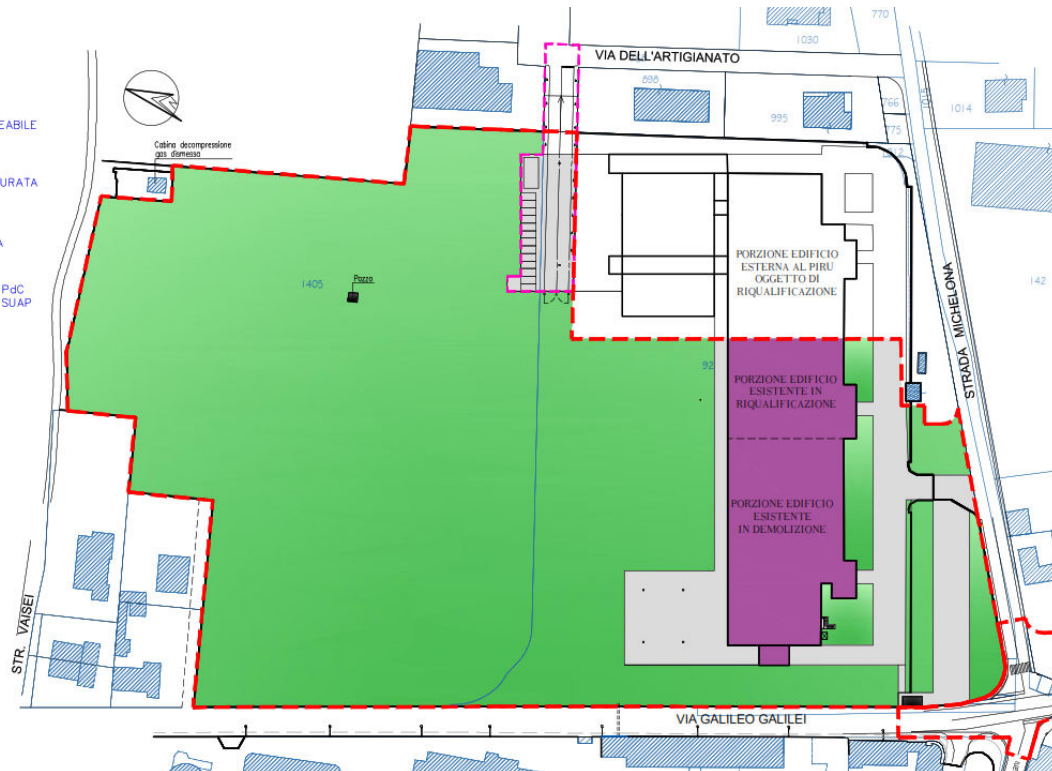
Planimetria dello stato di fatto con rilievo delle alberature e dell'occupazione del suolo
